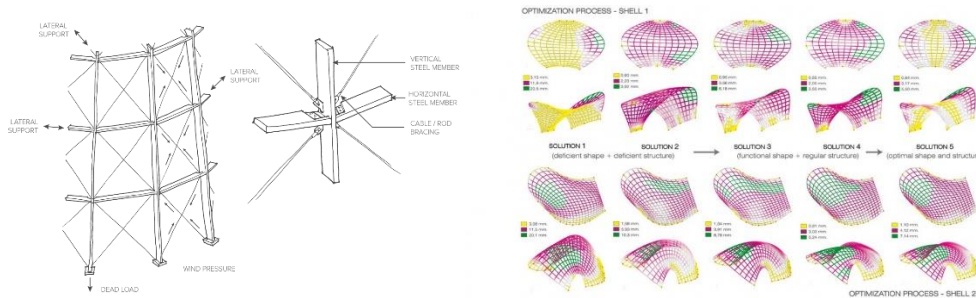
Struktur badan bangunan (sumber: <https://www.pinterest.pt/pin/552816923002285805/>)
